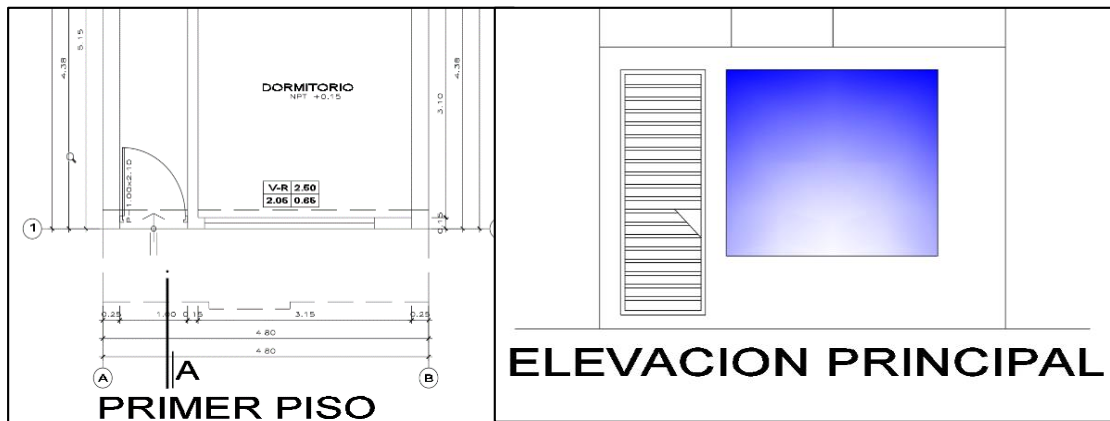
Representación de Columnas de Concreto y Paredes en CAD
